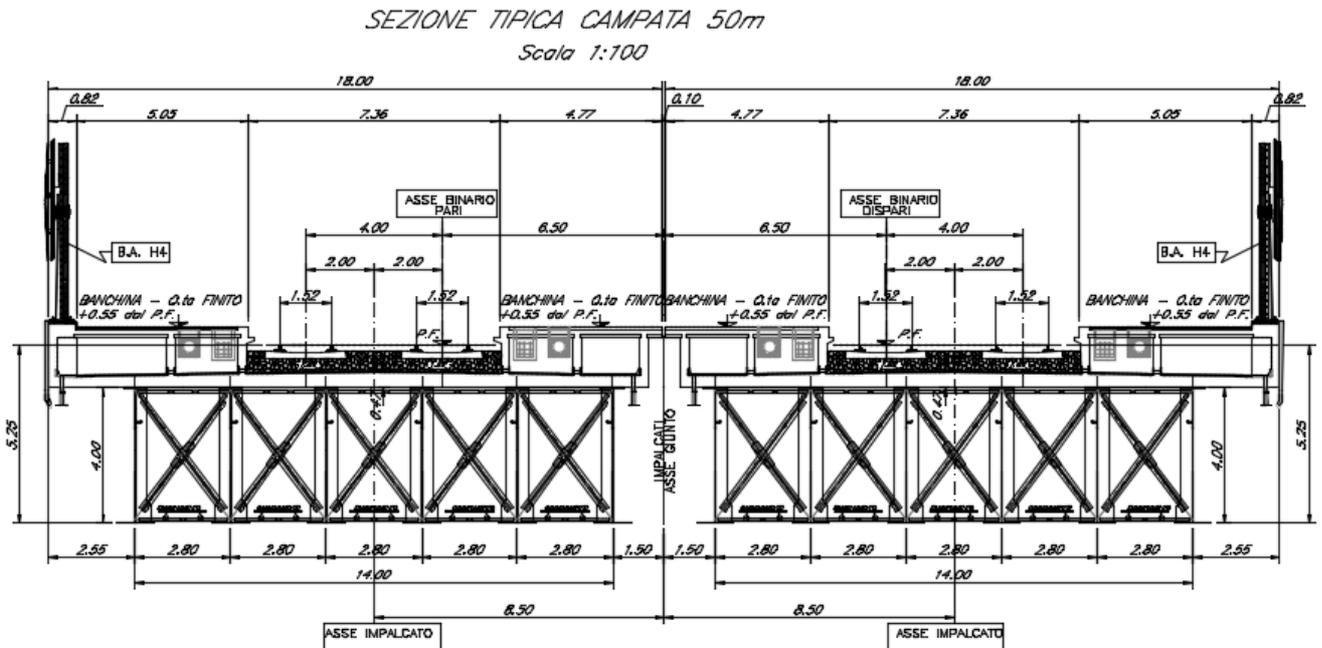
Viadotto fiumara d’Agrò: sezione trasversale e prospetto binario pari
